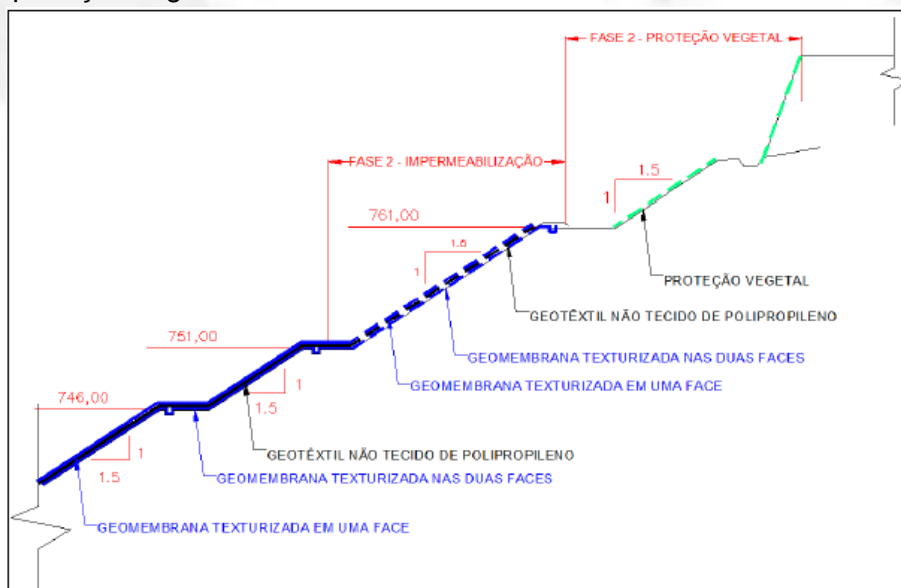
Sistema de impermeabilização entre as elevações 751 m e 761 m.
